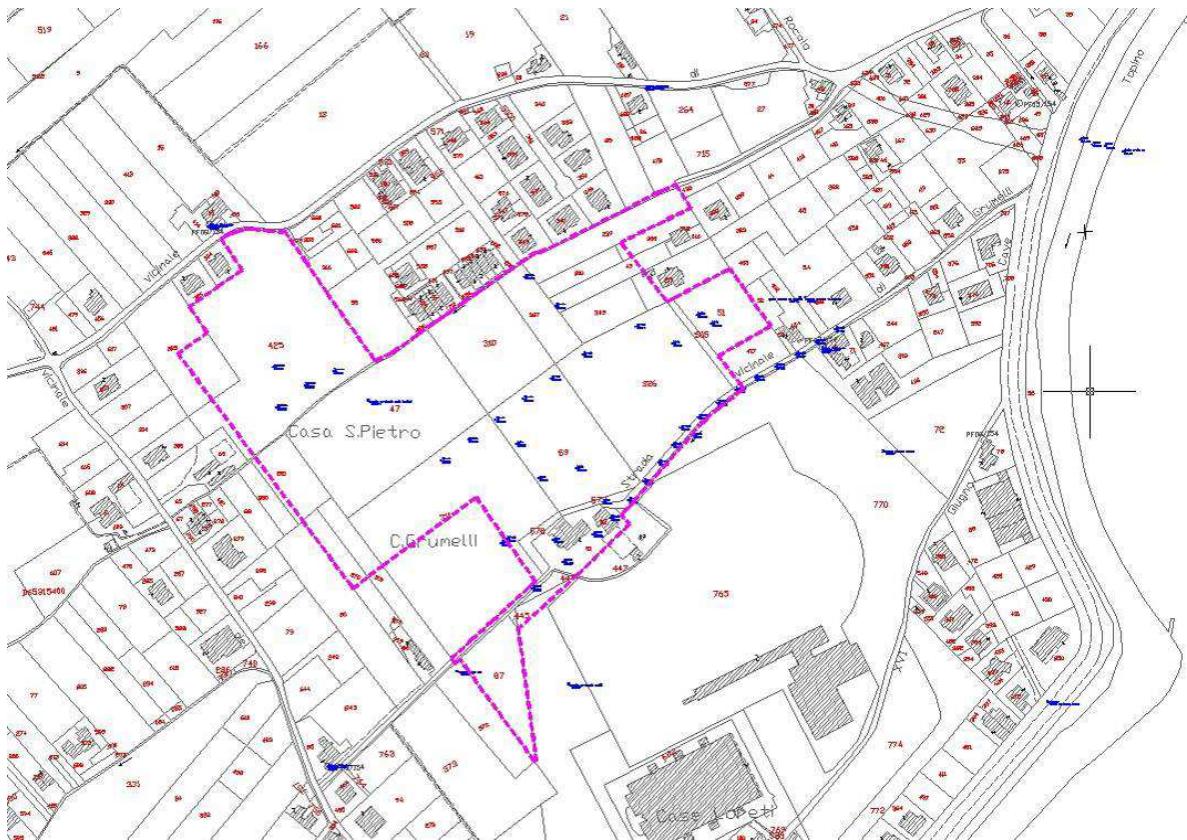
Area oggetto di intervento su Planimetria catastale
